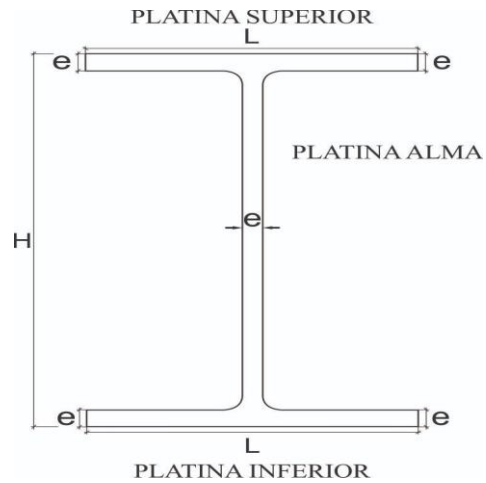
Dimensiones de la viga armada donde L es el largo de la sección transversal de la platina, e es su espesor y H es la altura total de la viga armada. Fuente: Propia.
